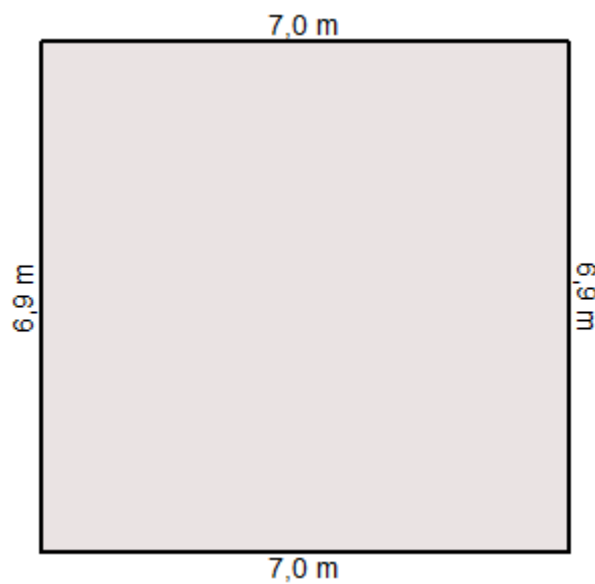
Grundriss (Bruttogrundfläche)
